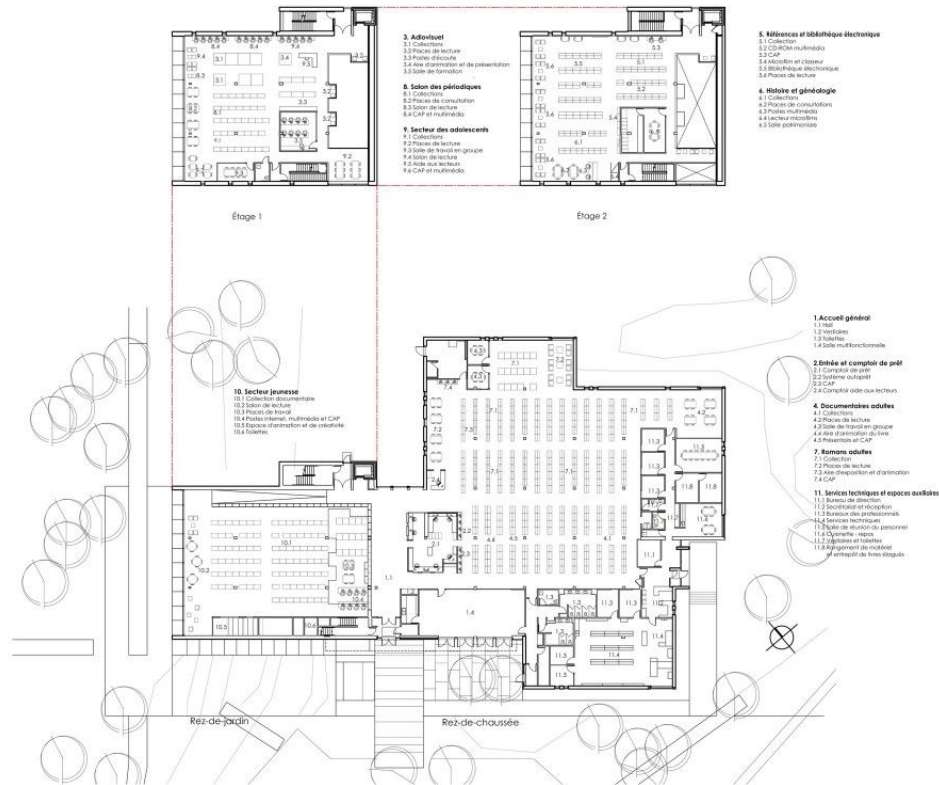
Planta baixa Biblioteca (PERREAULT, 2010).
